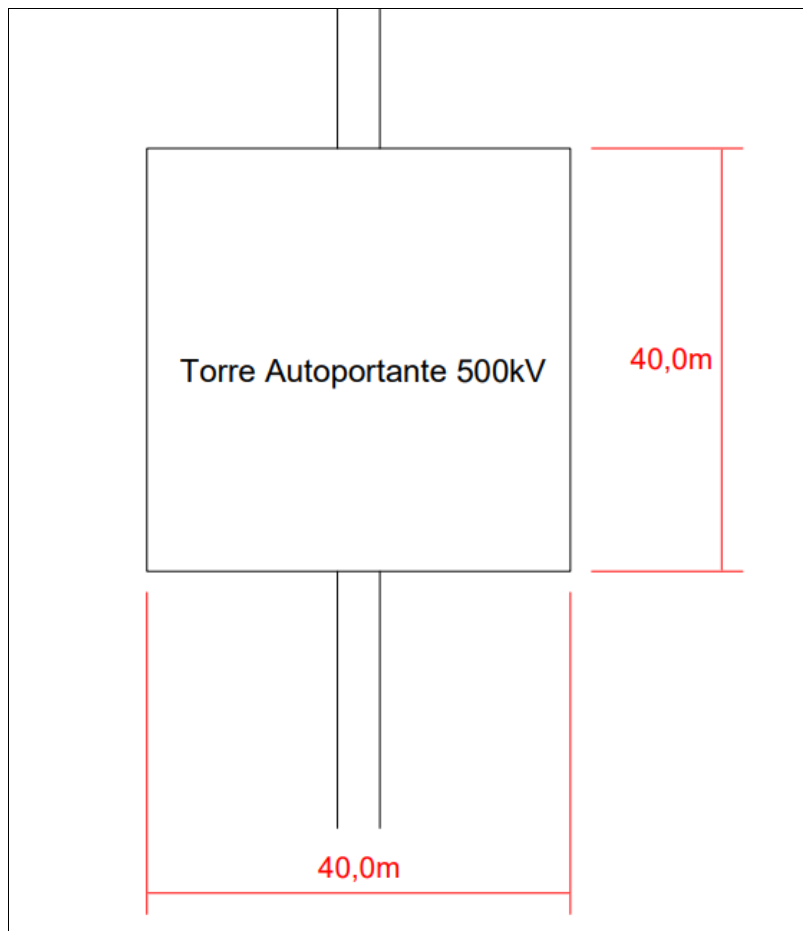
Croqui de supressão para implantação de torre autoportante.
